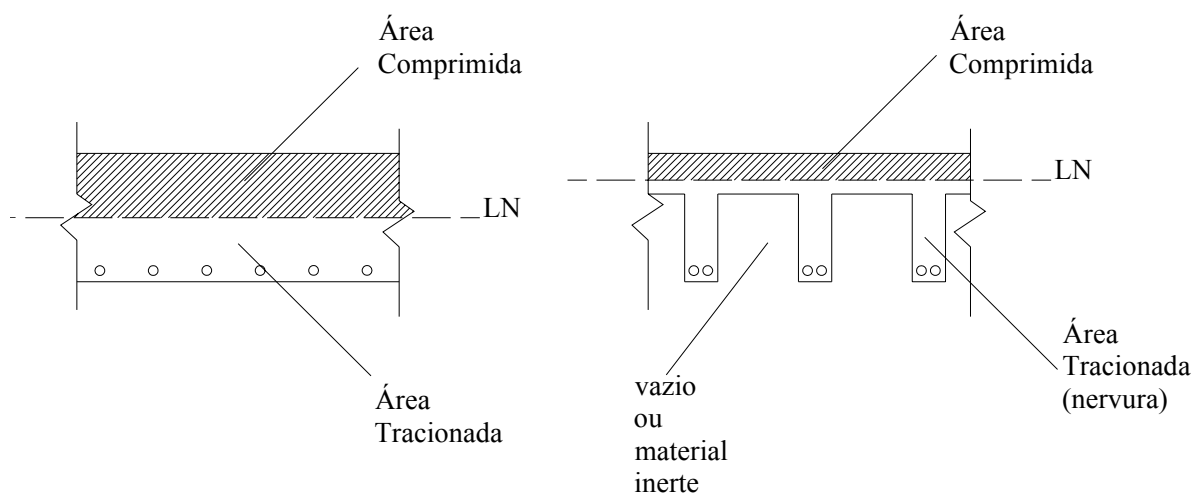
Seção transversal de laje maciça e laje nervurada submetida à flexão.
